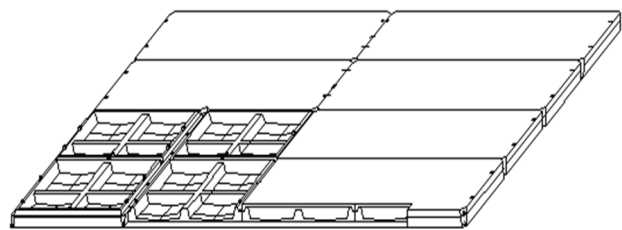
Пространственная железобетонная фундаментная платформа в сборном и сборно-монолитном варианте для малоэтажного строительства в сложных грунтовых условиях. Патент РФ № 69094
